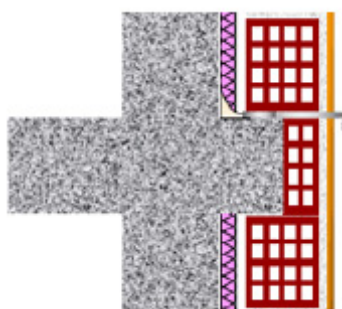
Aspecto construtivo bastante frequente na construção portuguesa [44]
